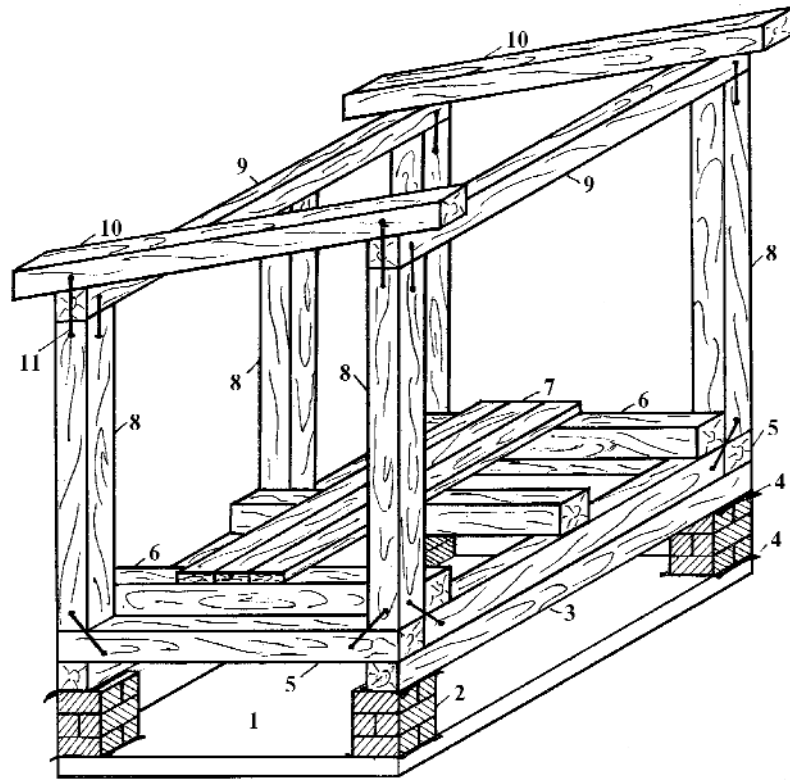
Принцип монтажа каркаса бани: 1 – фундаментная бетонная плита (размер плиты желательно делать на 0,5–1,0 м шире и длиннее бани), 2 – цокольные столбики (устанавливаются на расстоянии не более 2 м друг от друга), 3 – цокольная балка из железобетона, металлического двутавра, деревянного бруса (желательно вместо цокольной балки изготовить металлическую сварную кольцевую цокольную платформу жесткой конструкции), 4 – гидроизоляционные прокладки (два-три слоя рубероида), 5 – обвязка каркаса, 6 – половые лаги, 7 – половые доски, 8 – стойки, 9 – верхняя обвязка каркаса, 10 – лаги перекрытия (стропила), 11 – стальные столбы.
